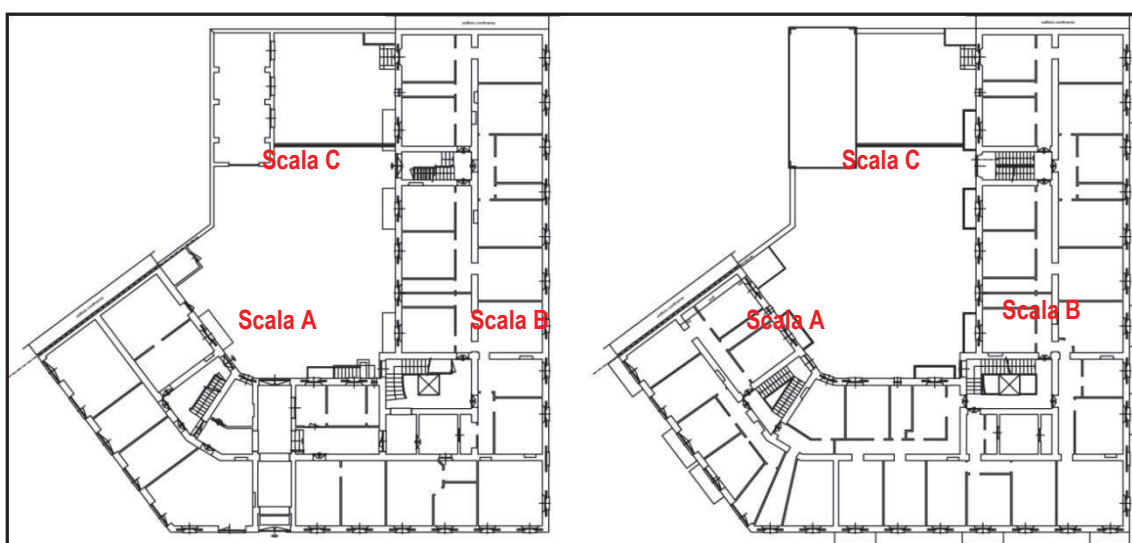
Pianta piano terra e piano tipo con indicazione dei vani scala
